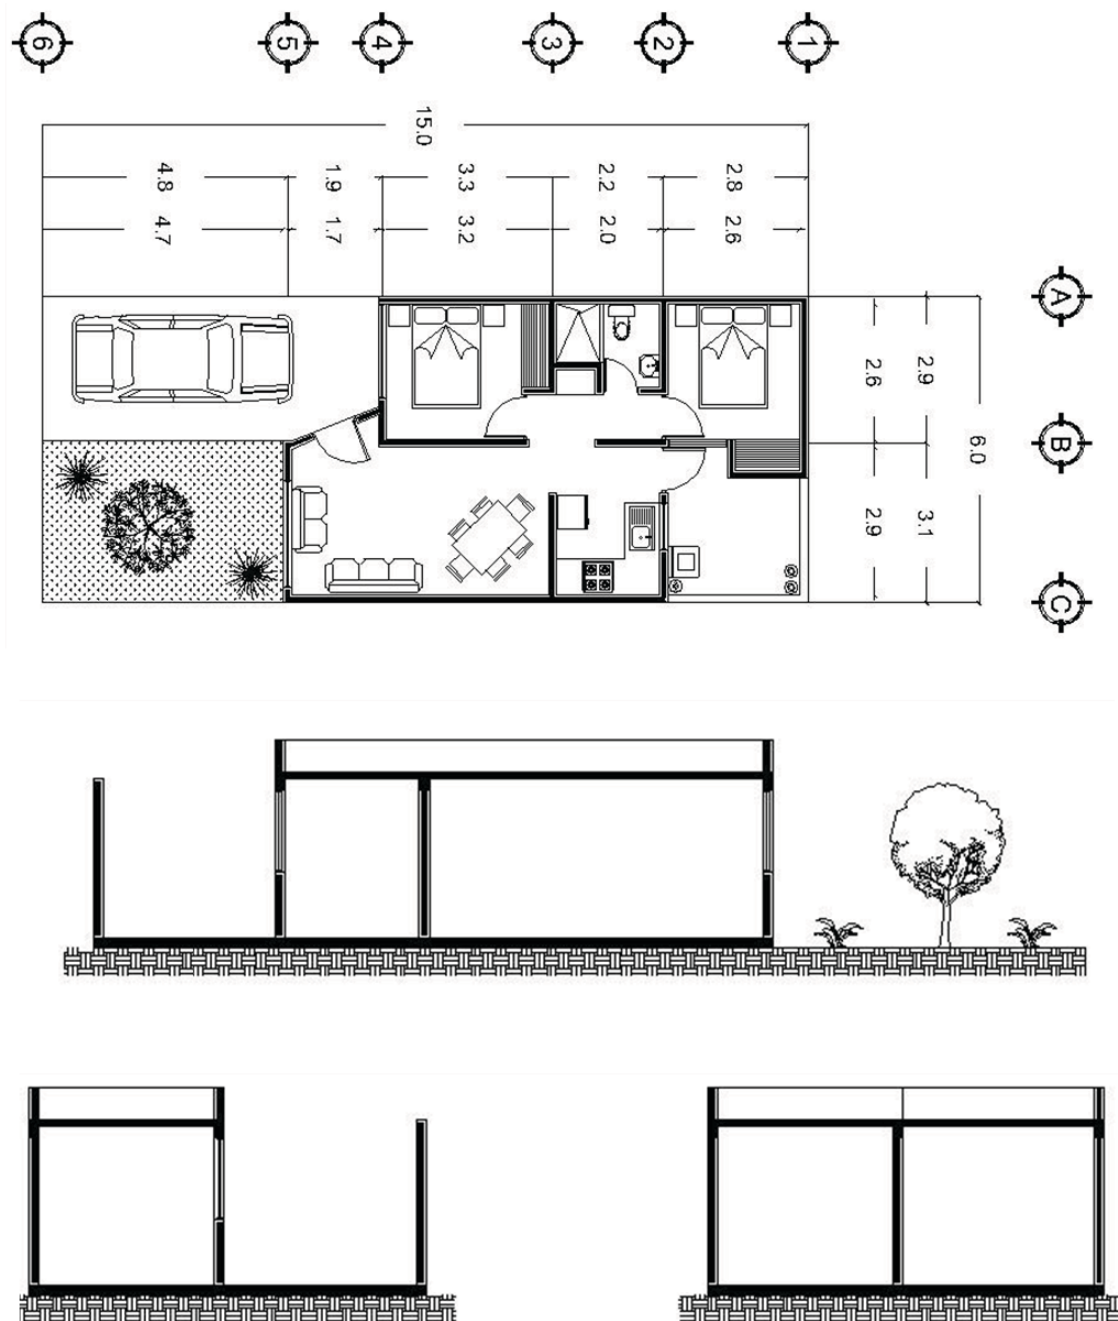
Planta y secciones arquitectónicas del prototipo de análisis
